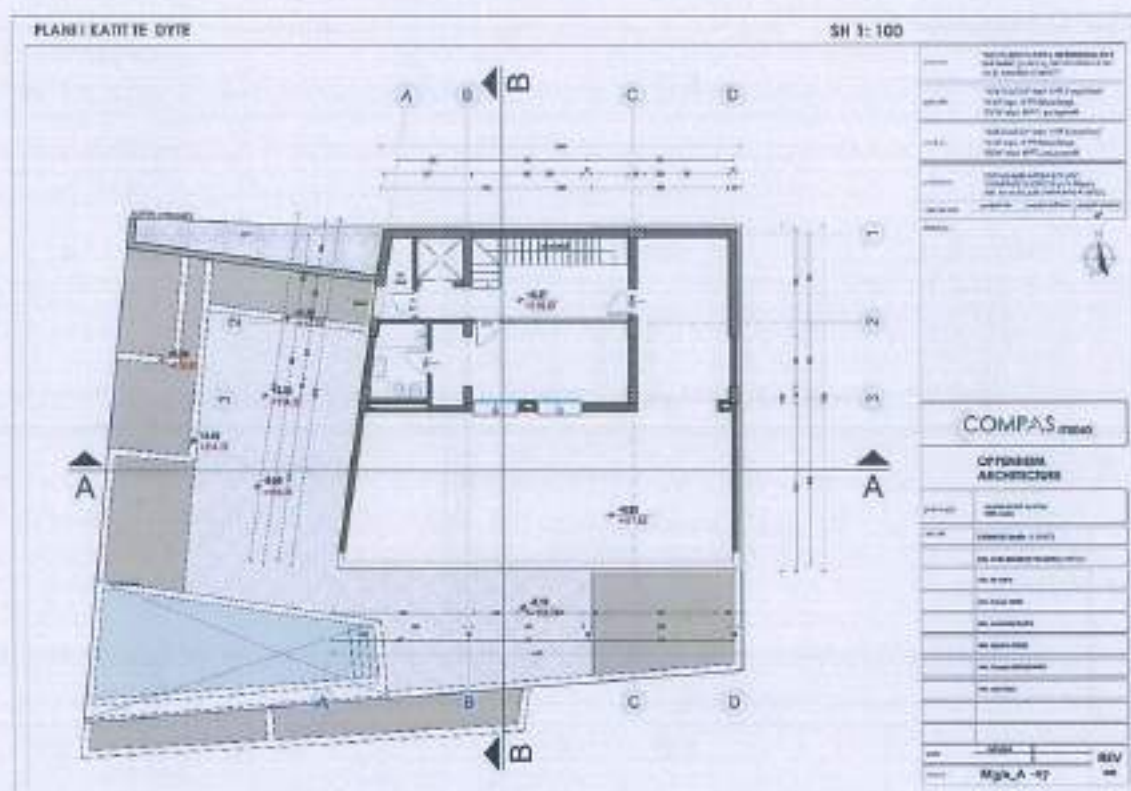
Vila M3/a \_Planimetria e katit të dytë
